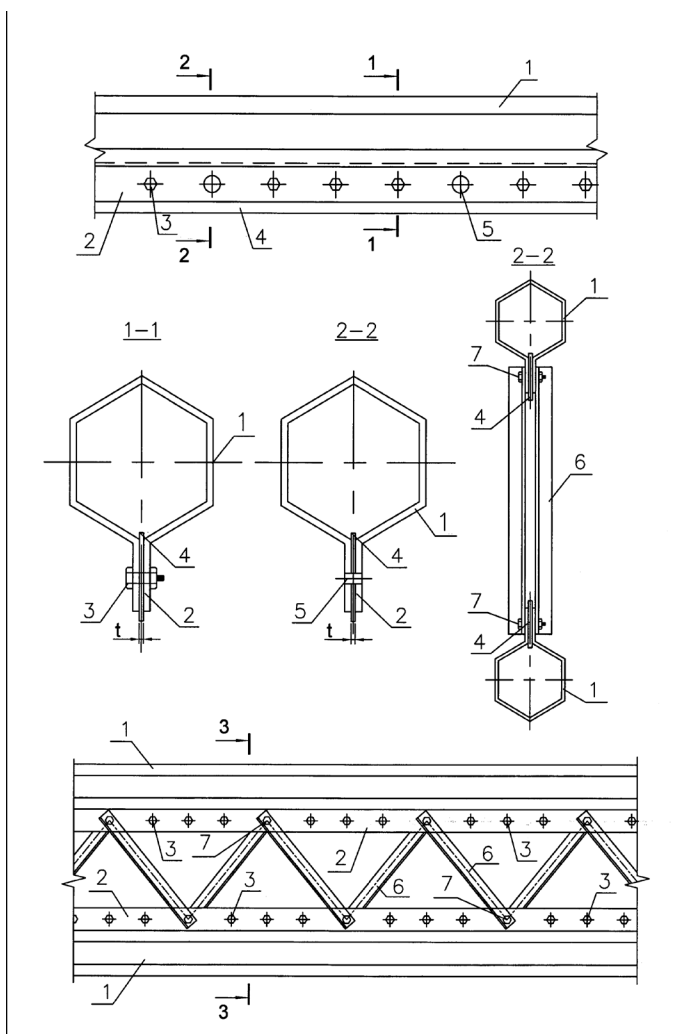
Схемы строительного элемента для изготовления решетчатых (ферменных) конструкций: 1 – поясной стержень замкнутого сечения; 2 – кромки ребра; 3 – поясной болт; 4 – листовая полоса; 5 – отверстие; 6 – стержень решетки; 7 – болтовое соединение пояса и стержней решетки
